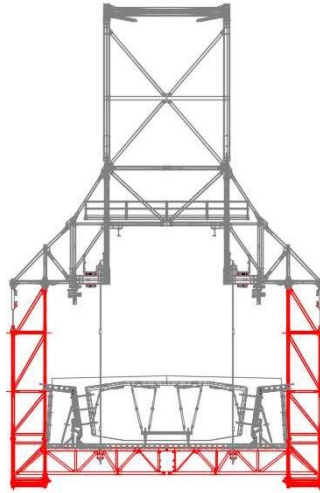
Estrutura transversal – Fase de betonagem.
